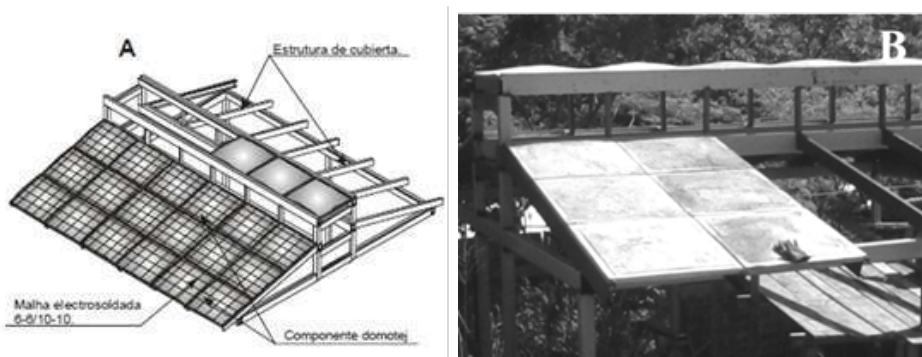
Los detalles del proceso de construcción del techo alternativo Domotej. En el gráfico se observa la colocación de la malla de refuerzo de acero en el recubrimiento de hormigón.
